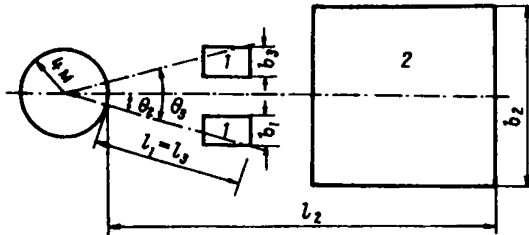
Схема к расчету пригрузок от поверхностных сооружений:
